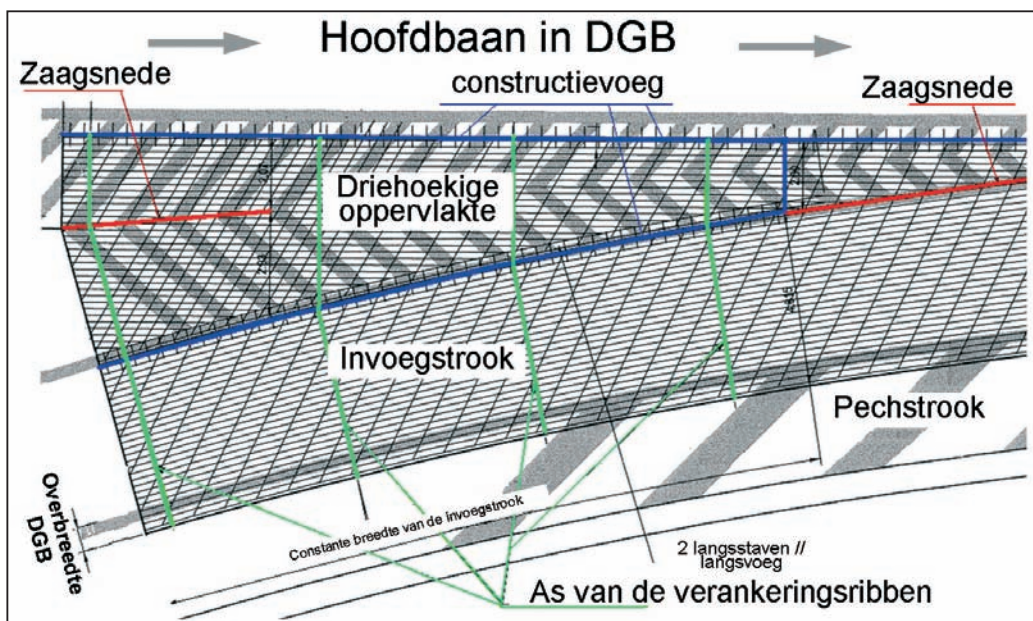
Gedetailleerde voorstelling van het wapeningsstaal in een invoegstrook
